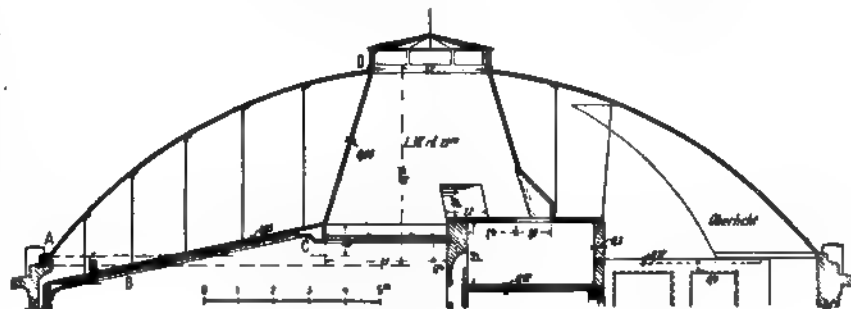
Anatomie München. Kuppel mit angehängter Decke und Lichtschacht.
